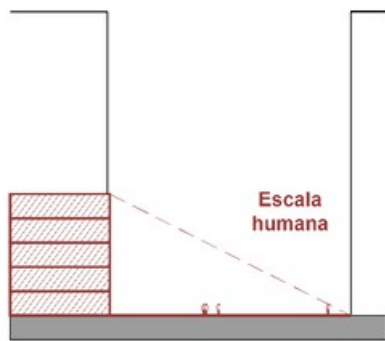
La proporción y la relación entre la calle y la arquitectura define las alturas de las nuevas edificaciones.
